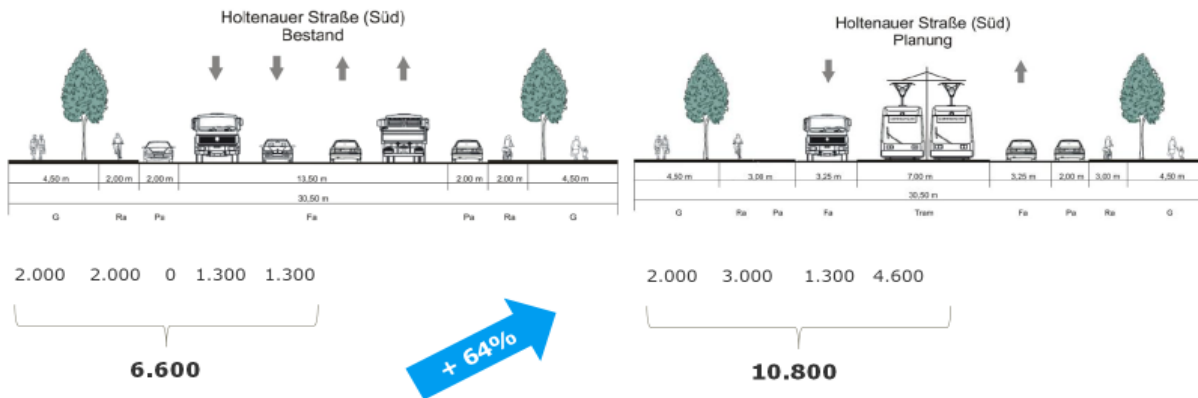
Exemplarische Kapazitätssteigerungen Holtenauer Straße mit HÖV-Trasse (Personen/Stunde)
